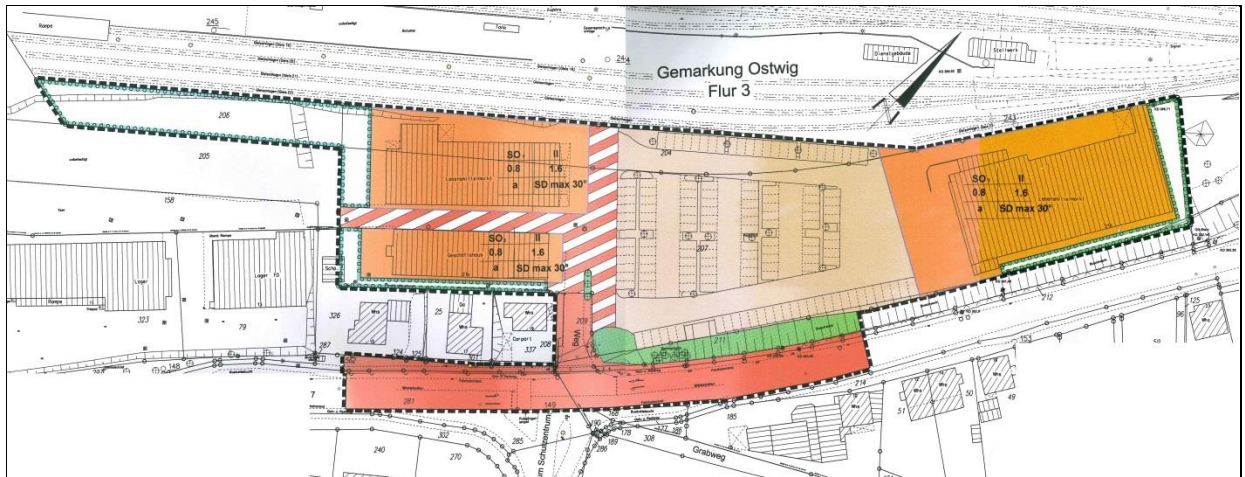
Auszug aus den zeichnerischen Festsetzungen zum B-Plan Nr. 134 „Märkte Borghausen“, Quelle: Gemeinde Bestwig
